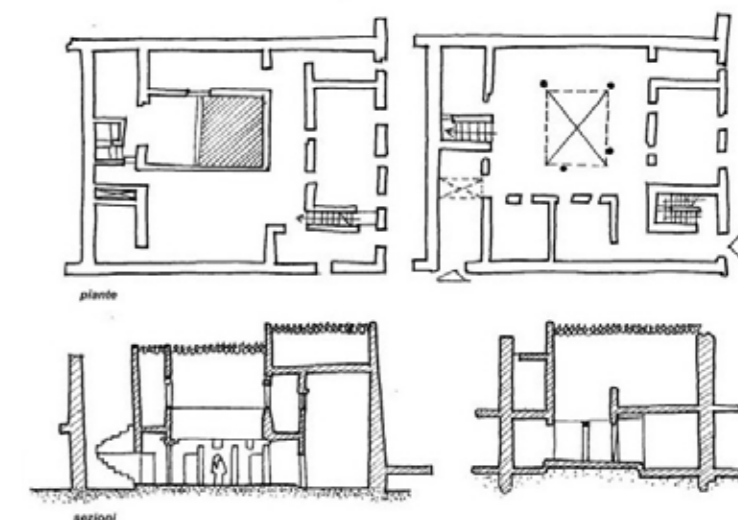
Schema funzionale di una tipica casa islamica a corte in pianta e in sezione
